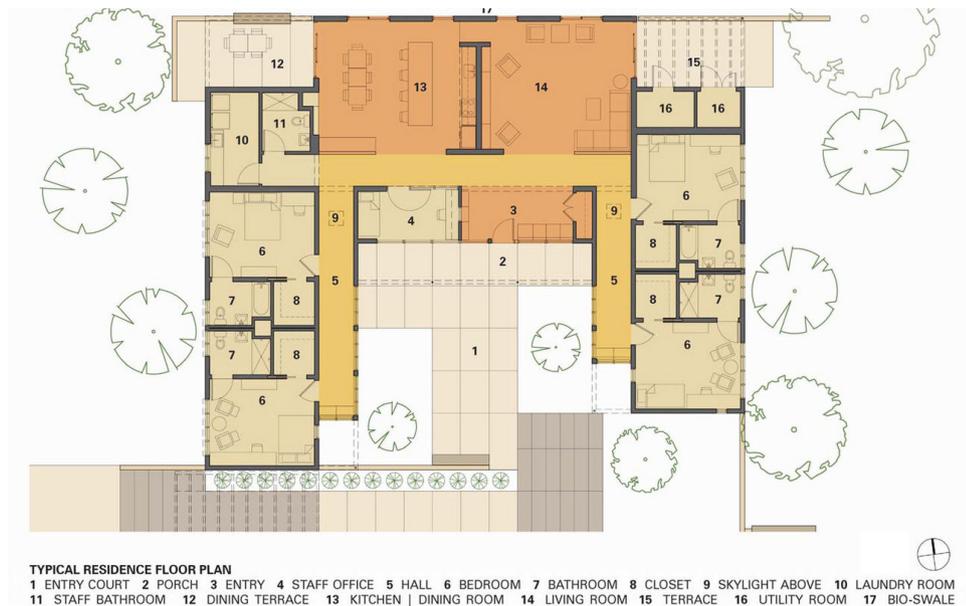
Pianta piano tipo residenziale (Fonte: Archdaily).
